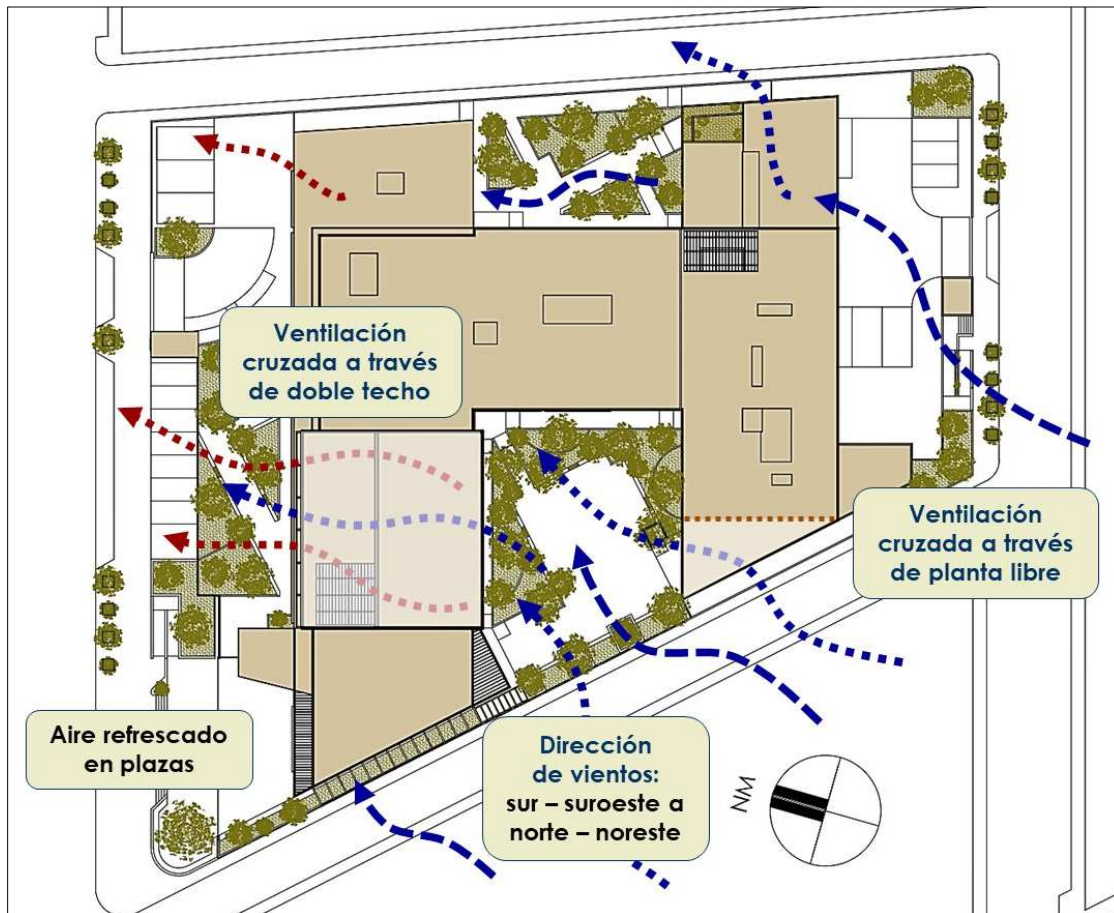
Planta Esquemática General sobre Ventilación del Proyecto
